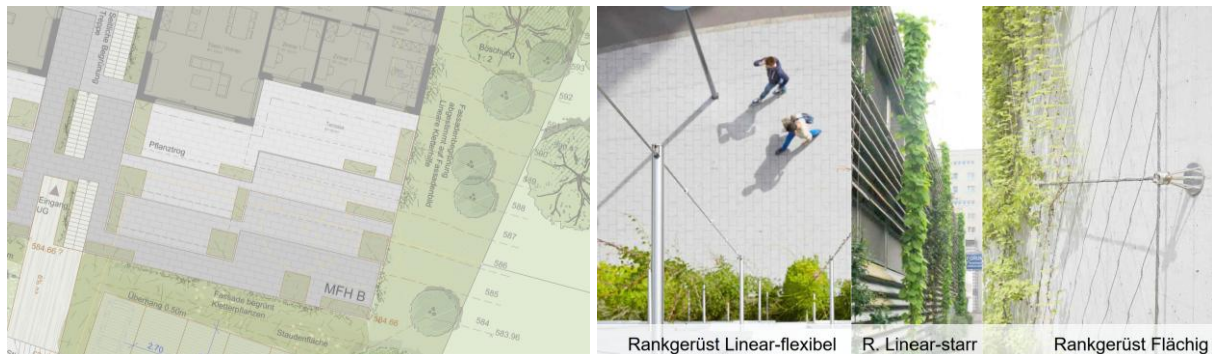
landschaftsarchitektonische Richtprojekt: Ausschnitt Fassadenbegrünung, Referenzbilder, Rankgerüste
